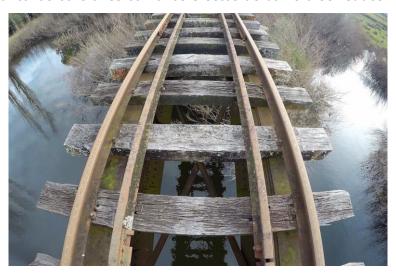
Los puentes "sin piso" por lo general son evitados por los animales. Para facilitar el movimiento se pueden incorporar plataformas por debajo del puente (A. Azpiroz)
